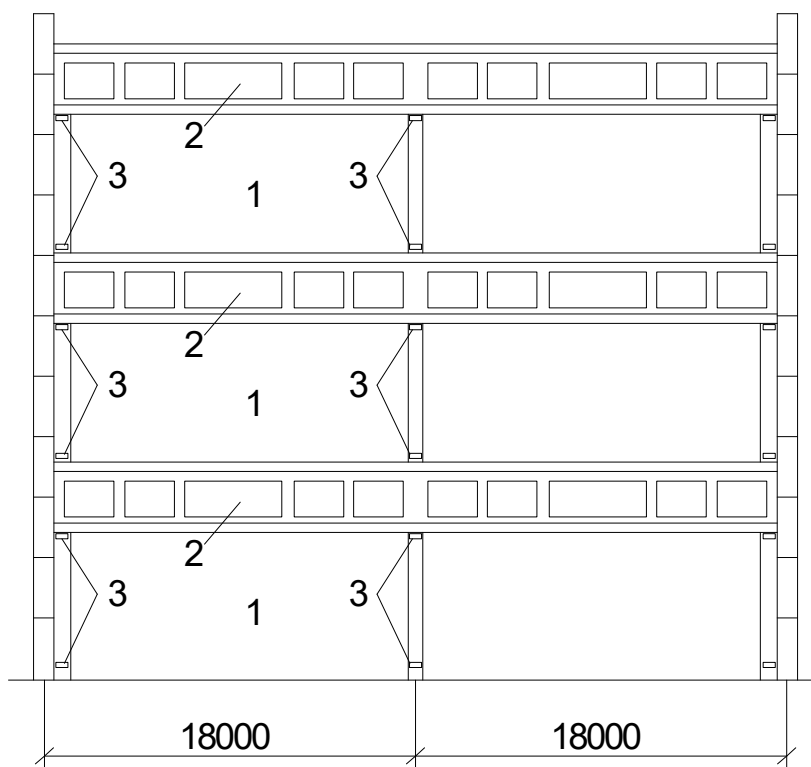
Конструкция многоэтажного промышленного здания с межферменными этажами
